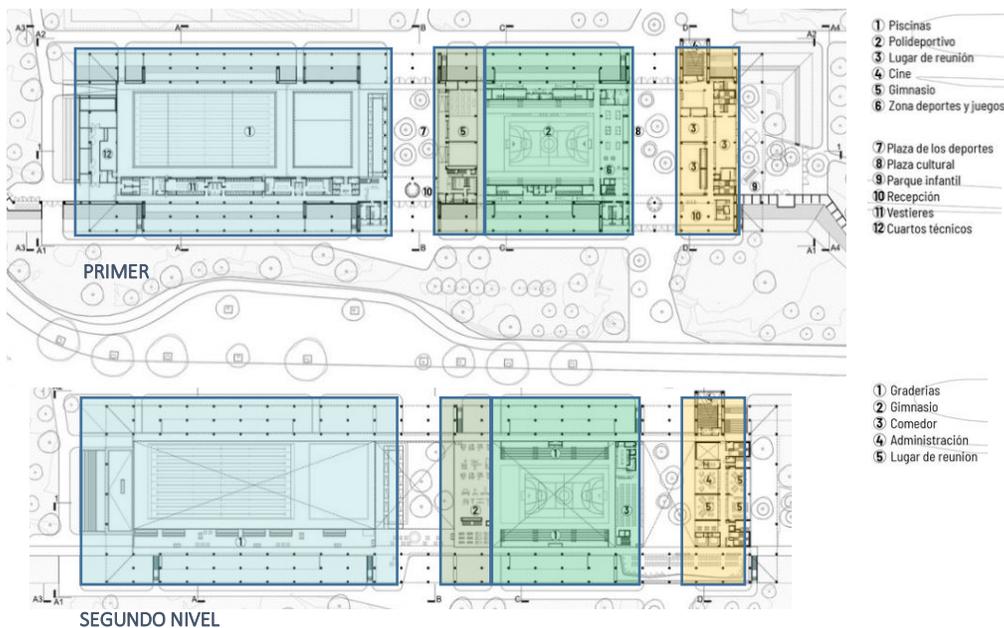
Plantas arquitectónicas del Centro Deportivo, Recreativo y Cultural.
